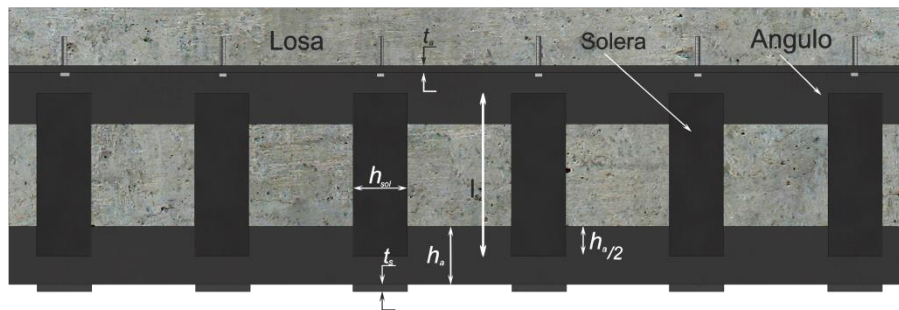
Sección longitudinal de viga encamisada con ángulos y soleras.
